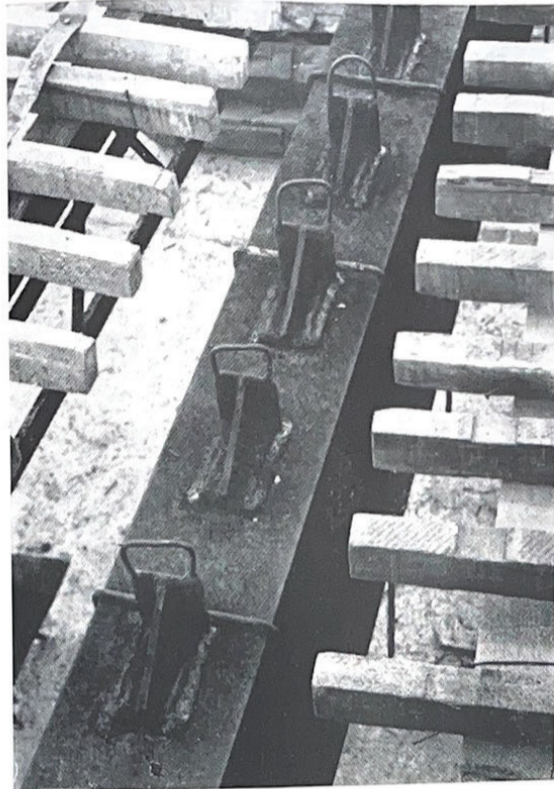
Detalhe das alças de amarração do concreto das lajes ao vigamento de aço.
